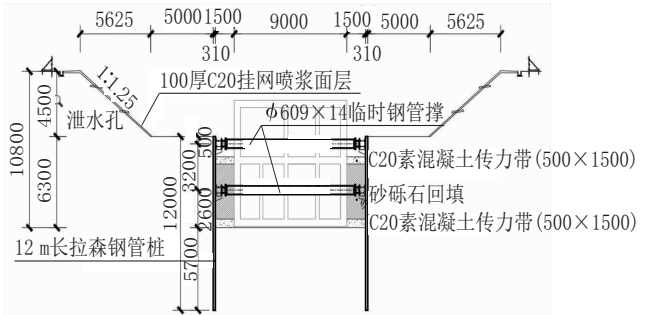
放坡开挖 + 钢板桩支护剖面图(单位:mm)
